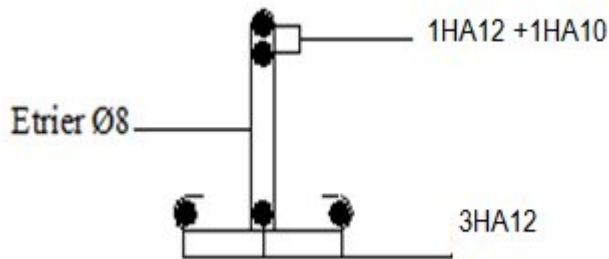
Schéma du ferrailage de la poutrelle.
